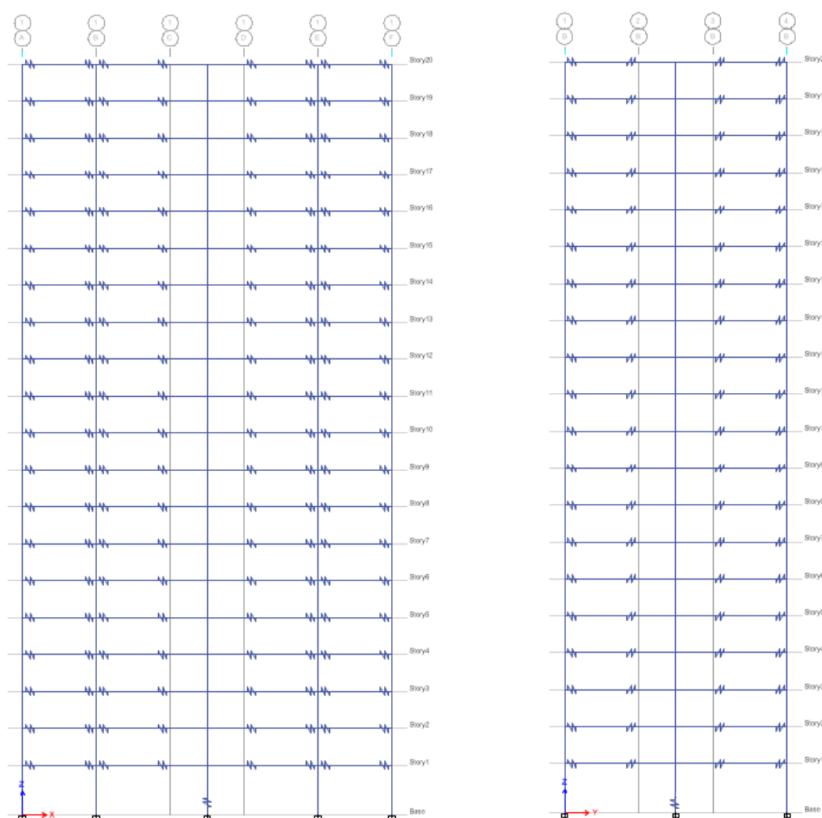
Distribución de rótulas perfectas en elevación estructura auxiliar Edificio Tipo 1
